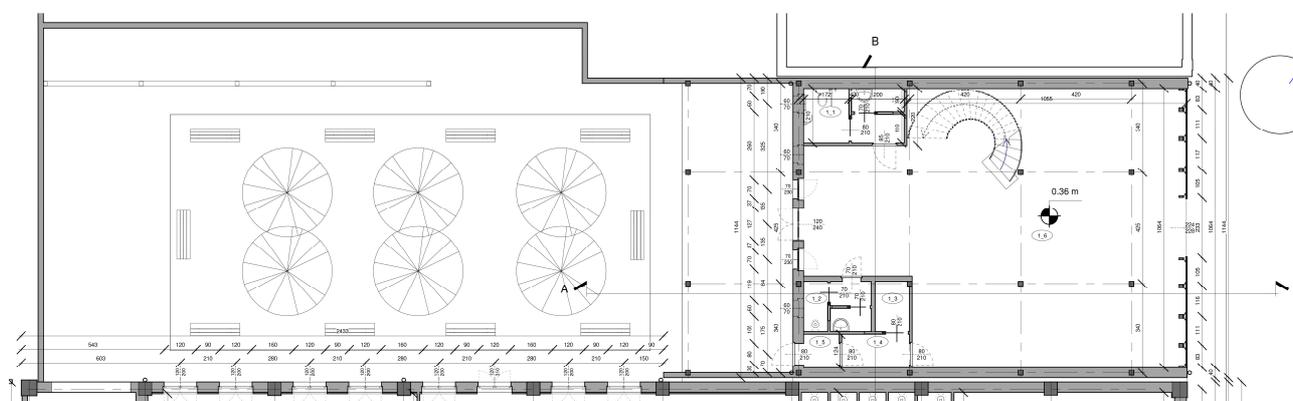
P. T. Bar (Tav. n°6 scala 1:100)
